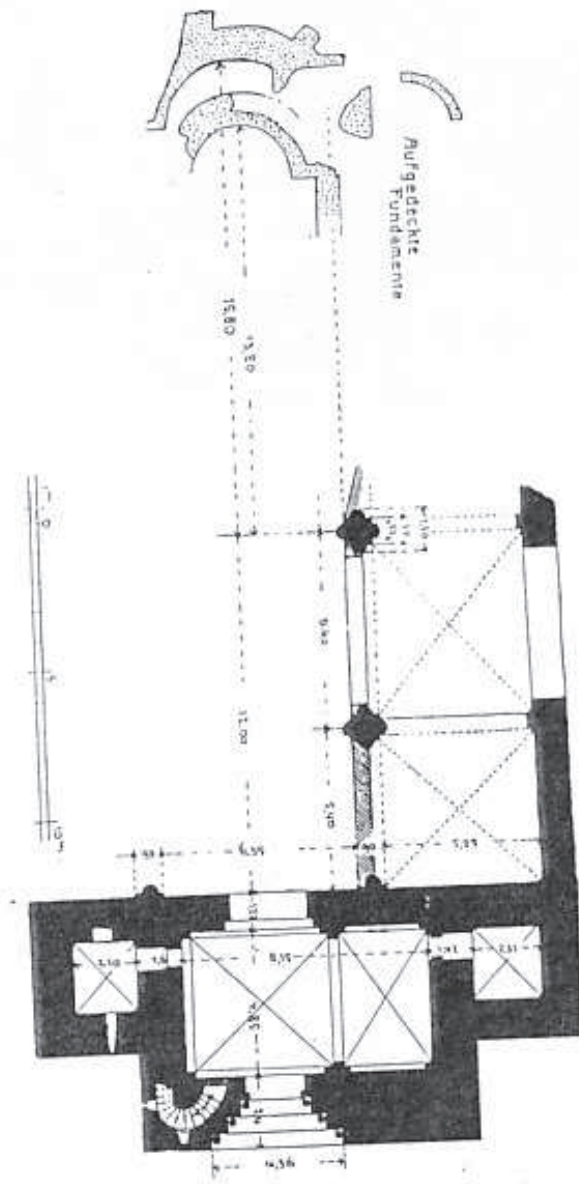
Marienkirche, Grundriss mit den durch Grabungen aufgedeckten Fundamenten der ersten beiden Chorschlüsse, vor 1919
